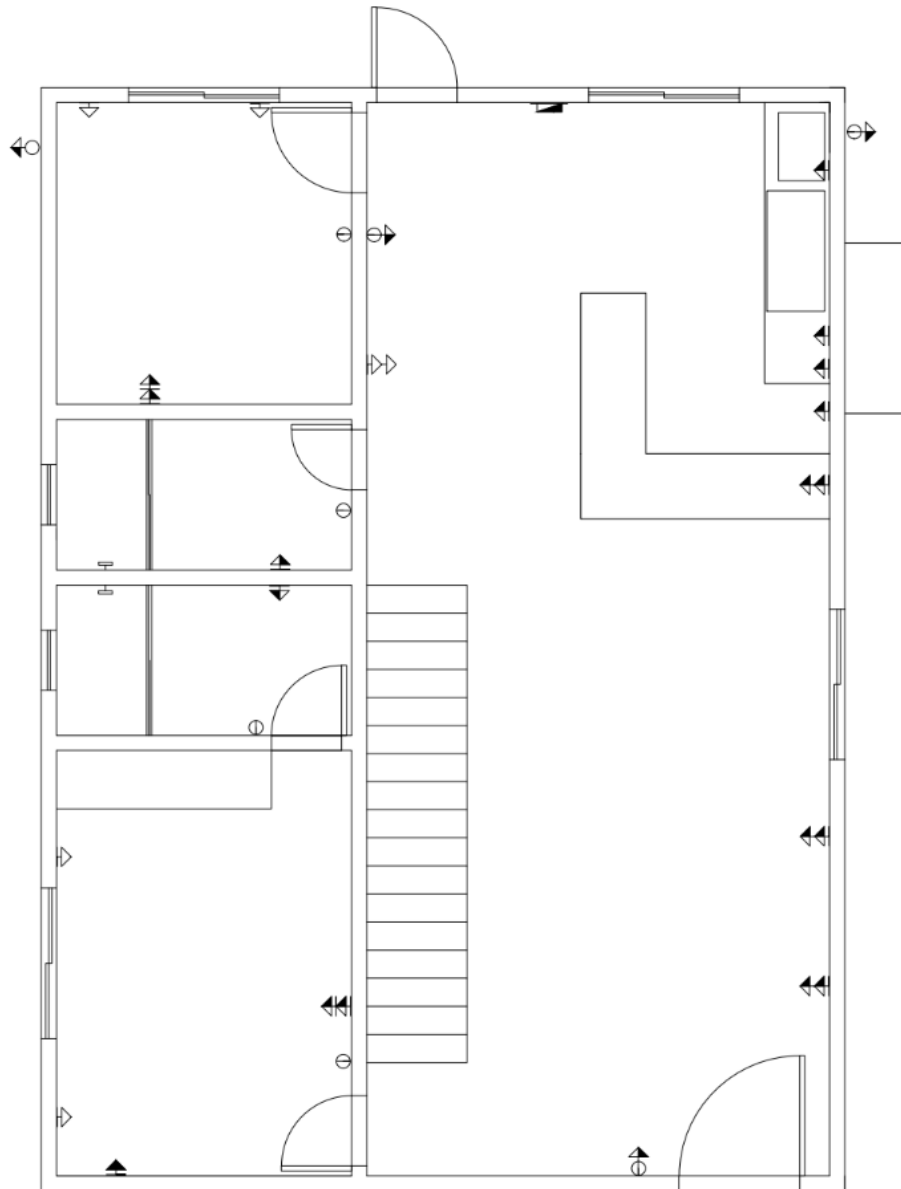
Planta baixa pontos de tomadas e interruptores pavimento térreo
